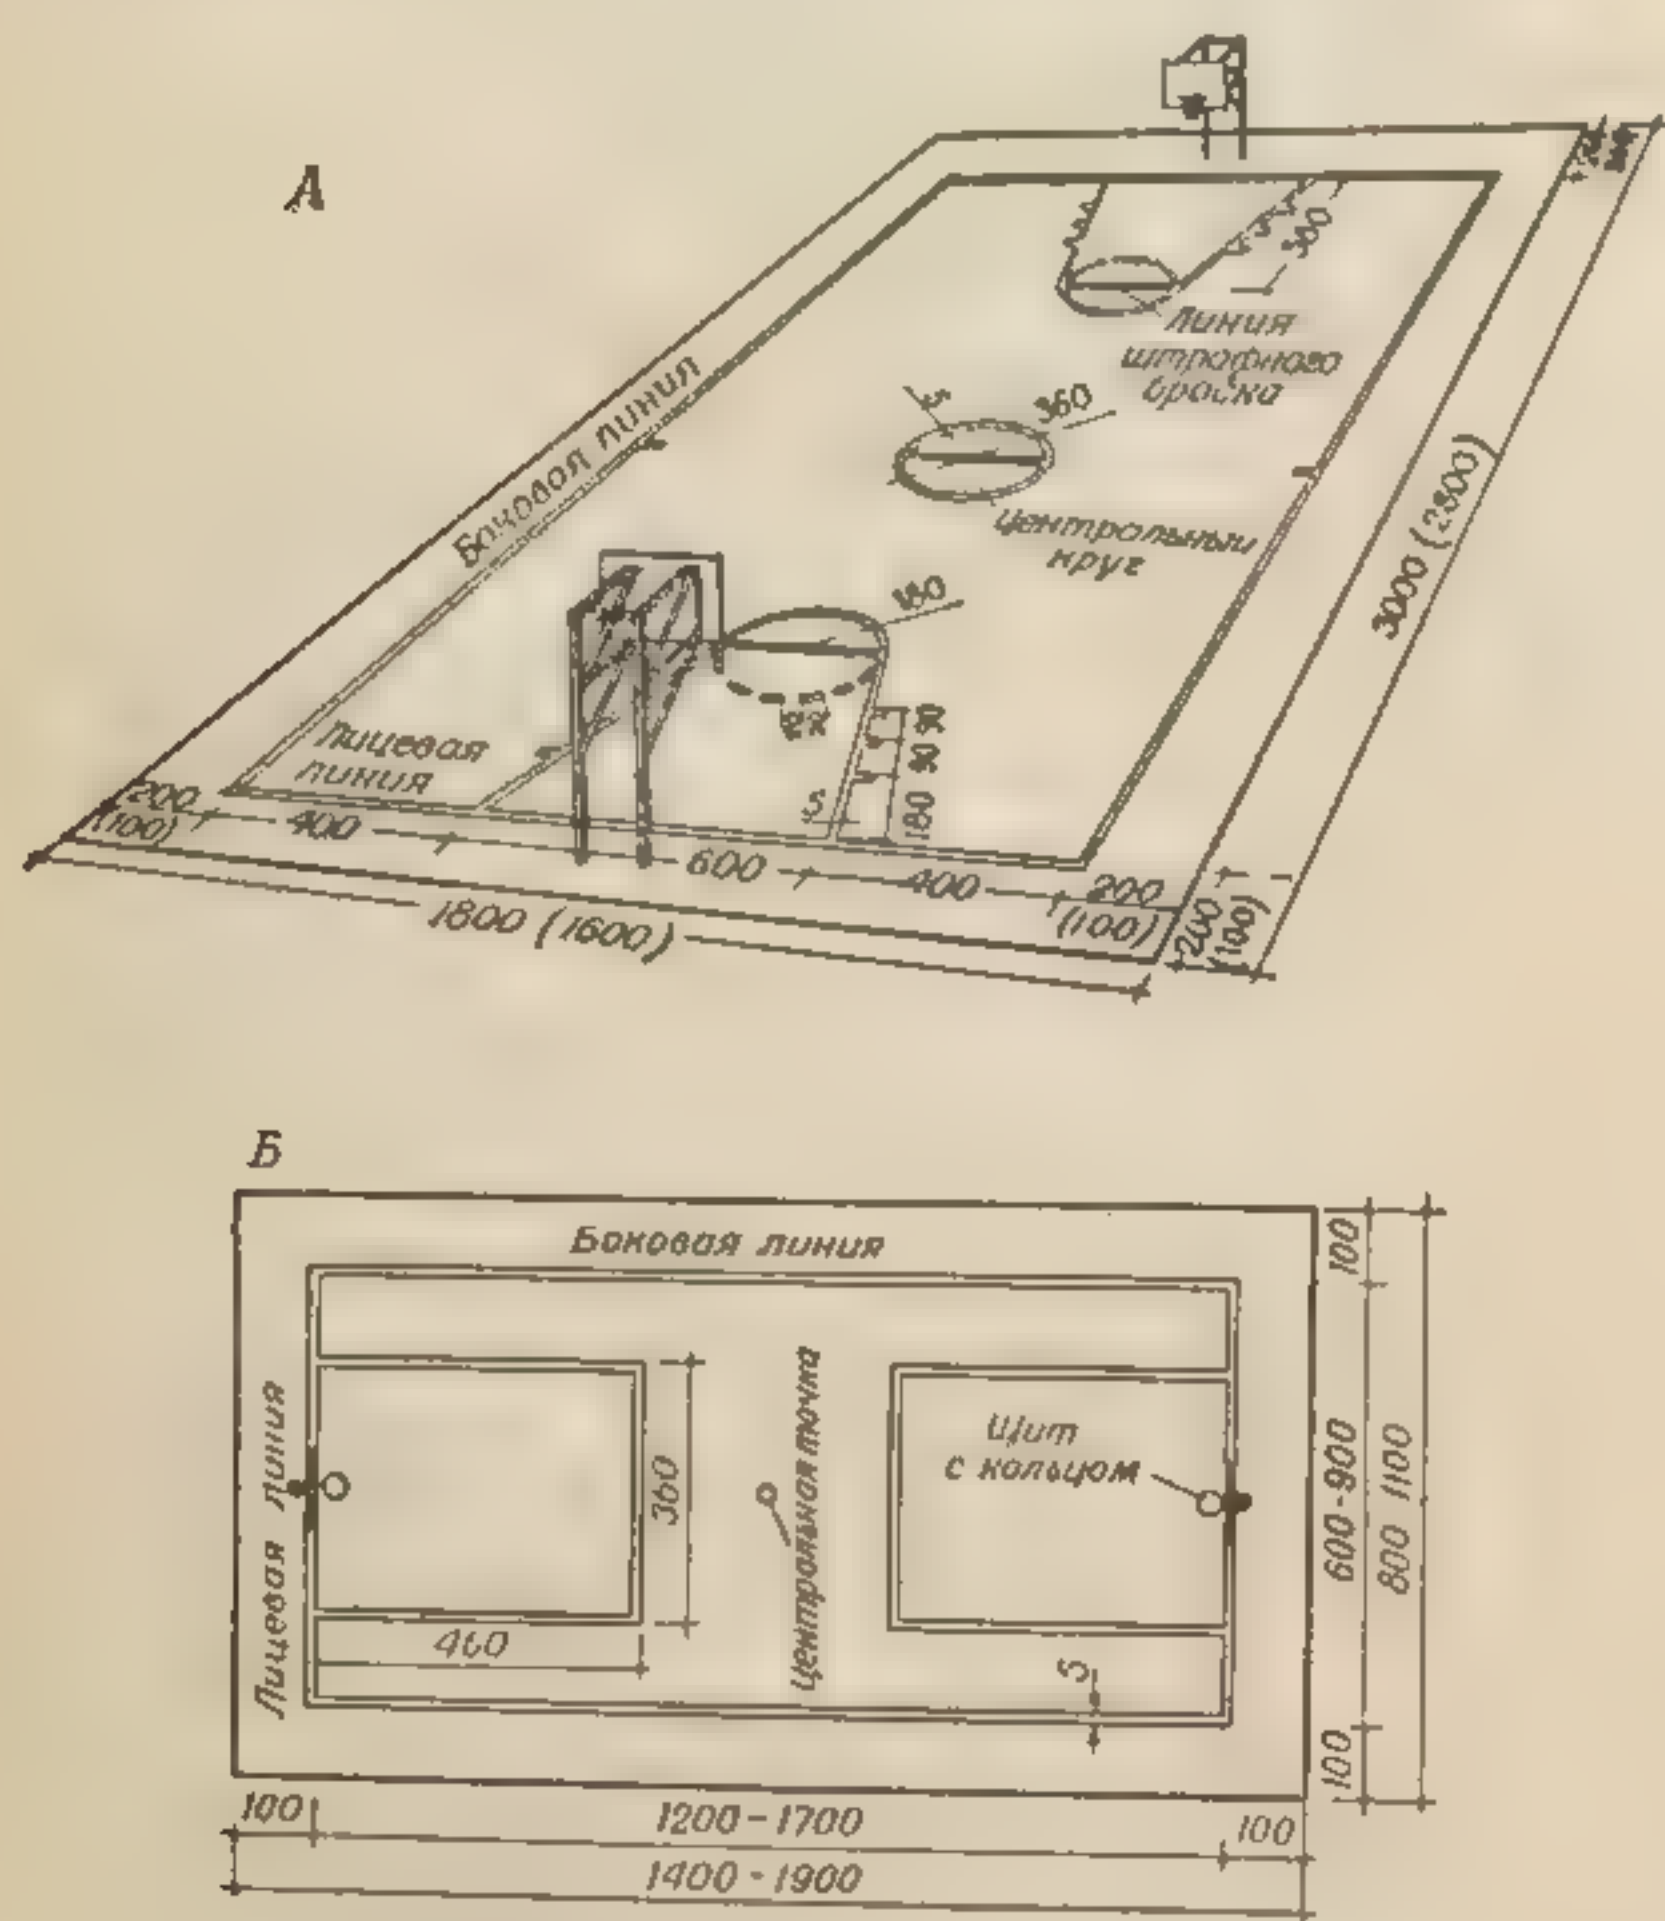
Площадка для баскетбола: А — стандартные размеры, установленные правилами соревнований; Б — минимальные размеры для игр по упрощенным правилам
